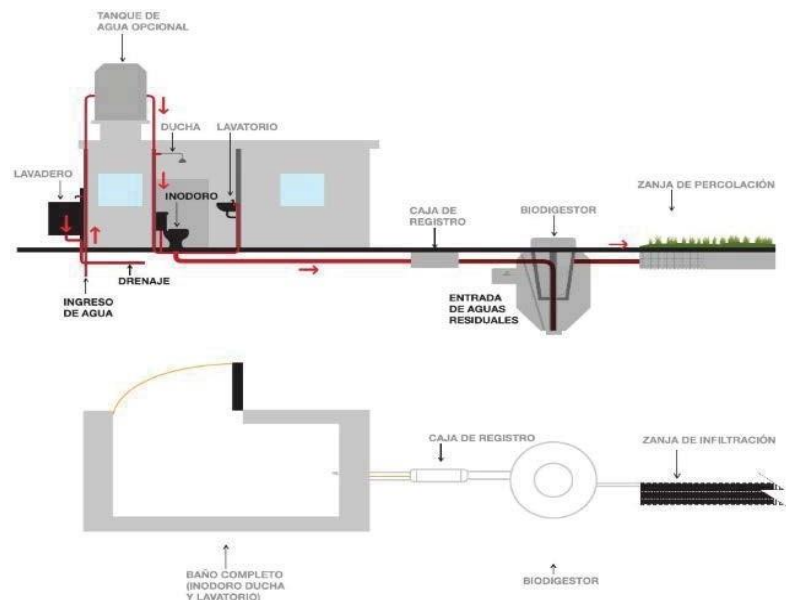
Vista en corte y planta de UBS de arrastre hidráulico con biodigestor
